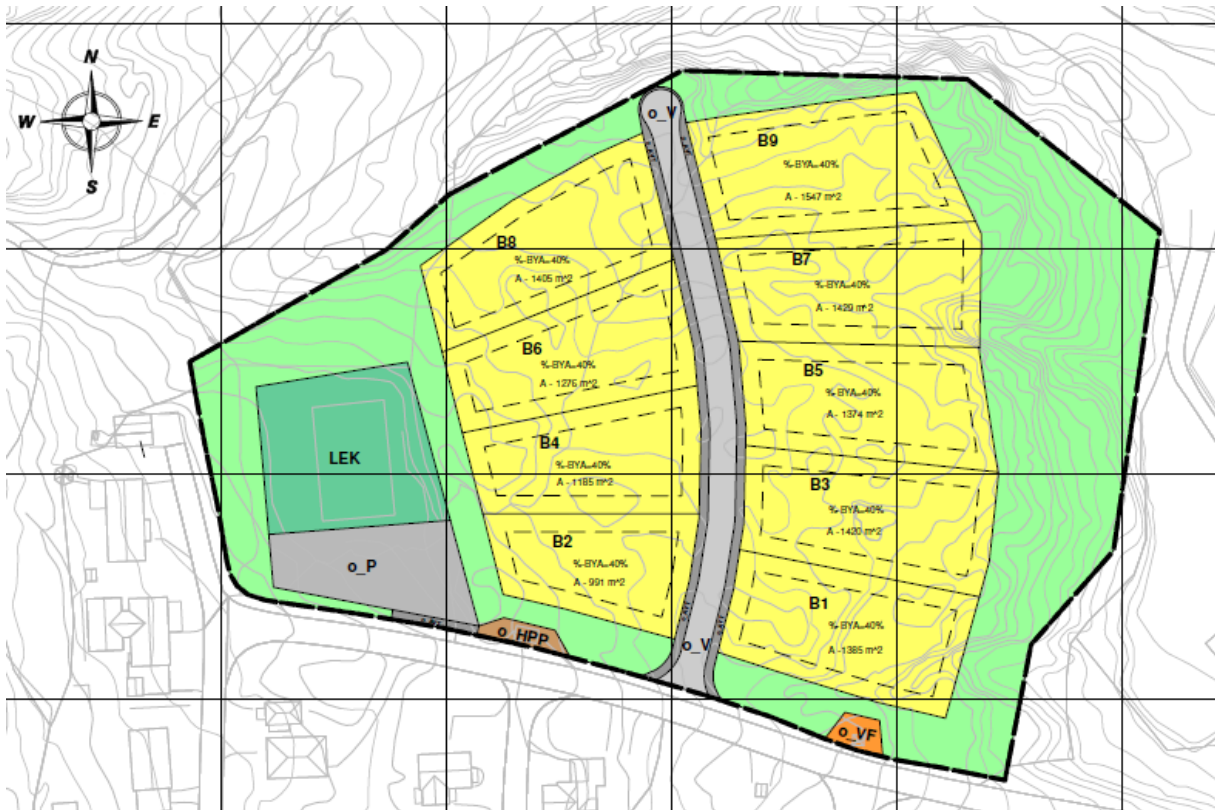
Eiendommer i og rundt planområdet (Lebesby kommune)
